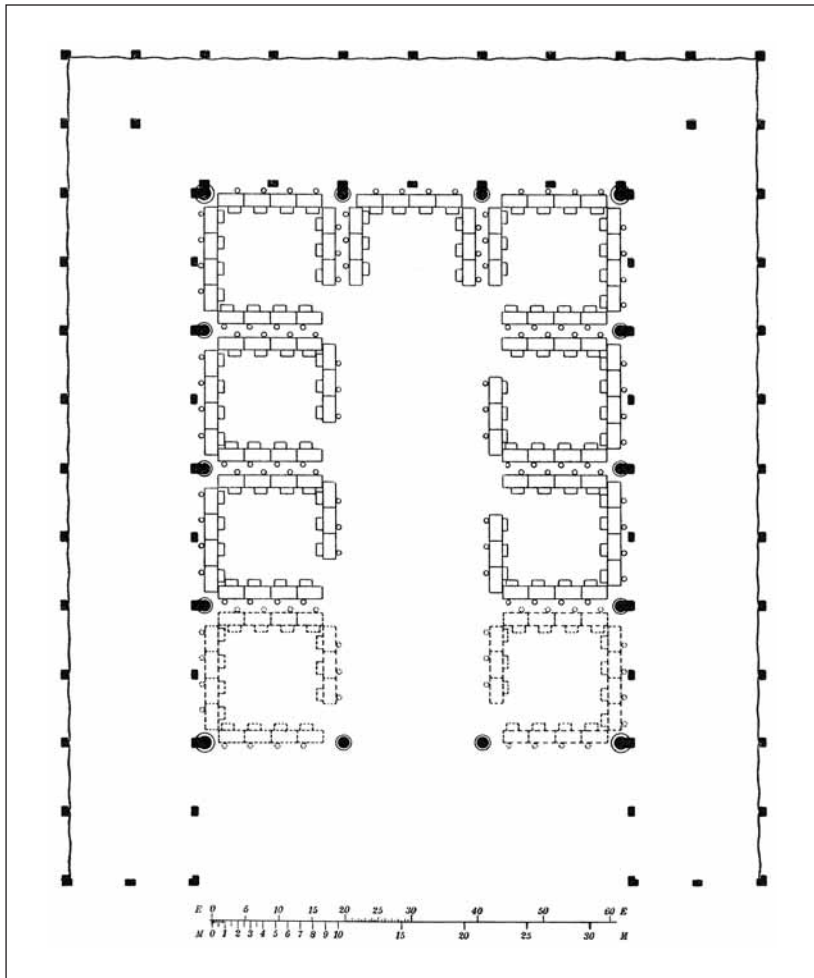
Alexandria, Bankettbau. Rekonstruierter Grundriss nach Studniczka 1914 (M. 1 : 600)
